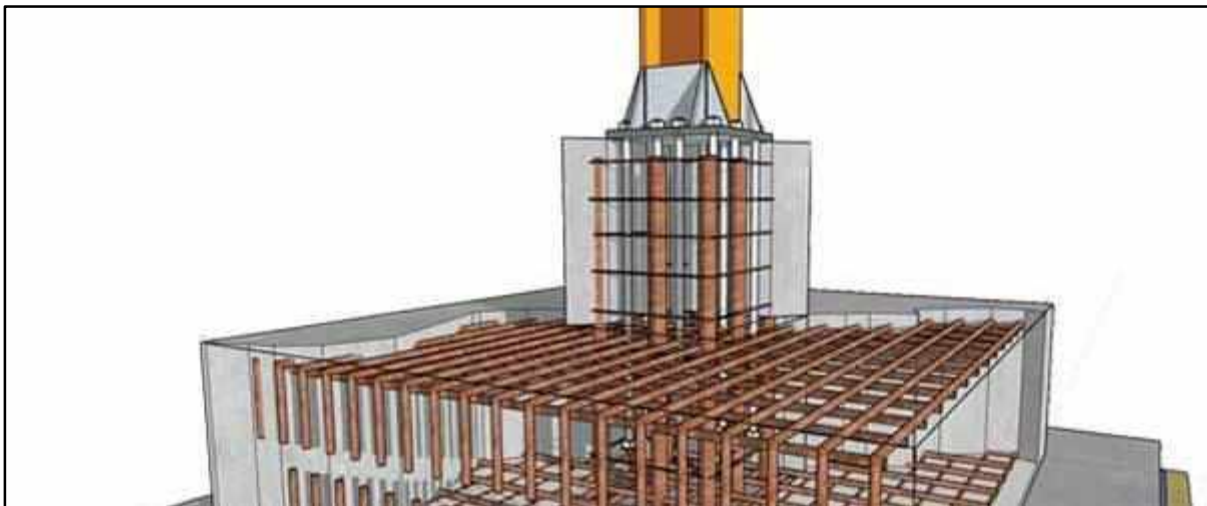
Detalle constructivo de sistema de zapatas y columnas de acero.
